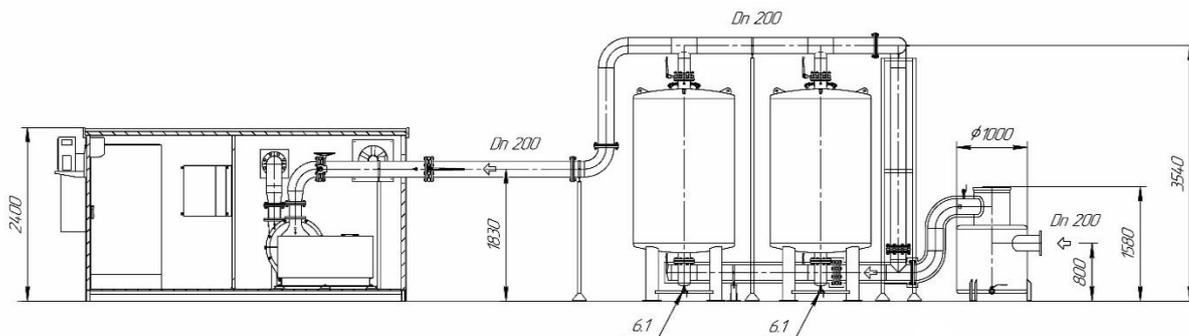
габаритные размеры и основные компоненты установки по обезвреживанию биогаза ЧЕЛЯБГАЗМАШ – ФУЗТ/1500С/УФ6. (1 - Конденсатосборник-газоосушитель; 1.1 - Шаровый кран слива конденсата Dn 2"; 2 - Датчик давления, диапазон 0/-400 мбар; 3 - Точка отбора проб с шаровым краном, Dn 1/2"; 4 - Затвор поворотный дисковый, Dn 200; 5 - Затвор поворотный дисковый, Dn 150; 6 - Угольный фильтр; 6.1 - Шаровый кран слива конденсата, Dn 1/2"; 7 - Затвор поворотный дисковый с приводом, Dn 200; 8 - Антивибрационное соединение; 9 - Компрессор-воздуходувка 1500 м³/час, 30 кВт; 10 - Датчик температуры; 11 - Датчик давления, диапазон 0/+400 мбар; 12 - Датчик потока; 13 - Переключатель давления; 14 - Пламегаситель, Dn 150; 15 - Клапан электрический основной линии, Dn 150; 16 - Клапан электрический пилотной линии, Dn 1/2"; 17 - Факел высокотемпературный, 1500 м³/час, 18 – Контейнер; 18.1 - Датчик утечки газа; 18.2 – Вытяжка; 18.3 - Радиатор отопления; 19 - Панель управления; 19.1 - Внешний модуль панели управления; 20 - Система анализа биогаза; 21 - Система анализа выбросов)
